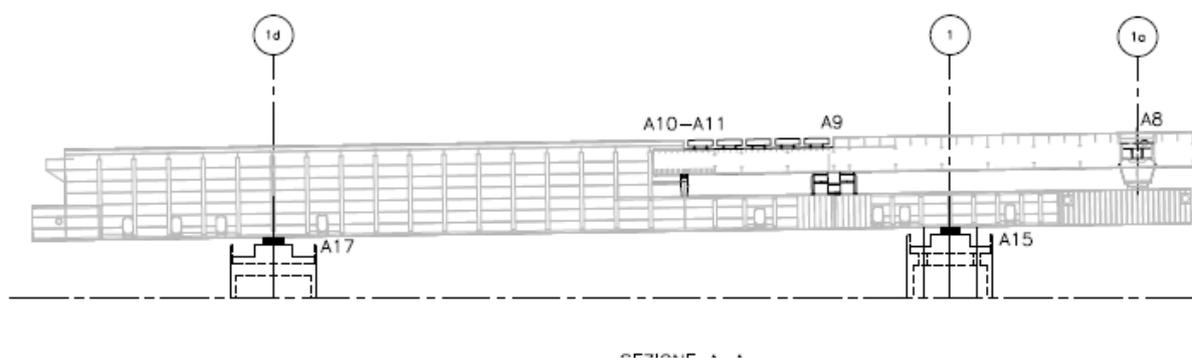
Disposizione degli appoggi alla struttura terminale lato Sicilia – vista laterale (sezione B-B in Figura 6-8).
